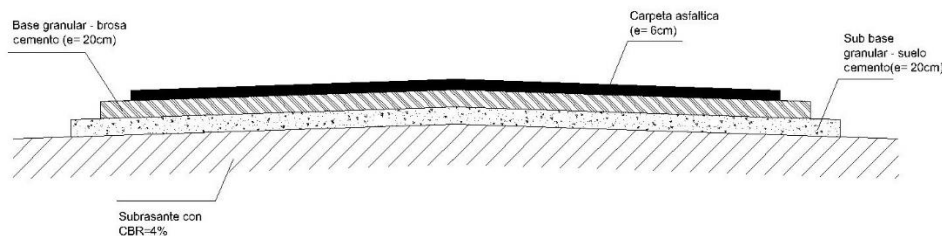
Paquete estructural a utilizar. Fuente: Elaboración propia.
